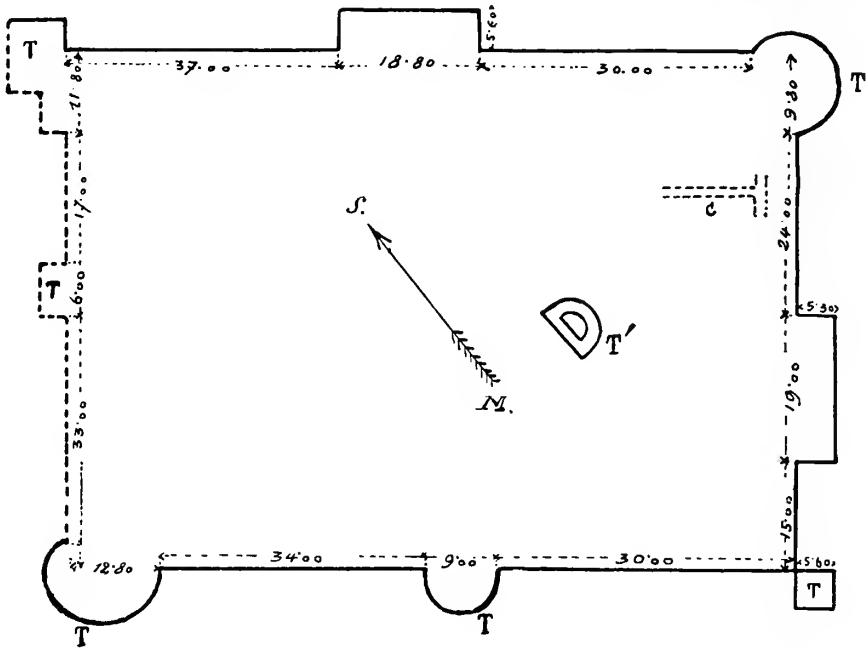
Grundriss des befestigten römischen Lagers bei Struge (Hercegovina).
